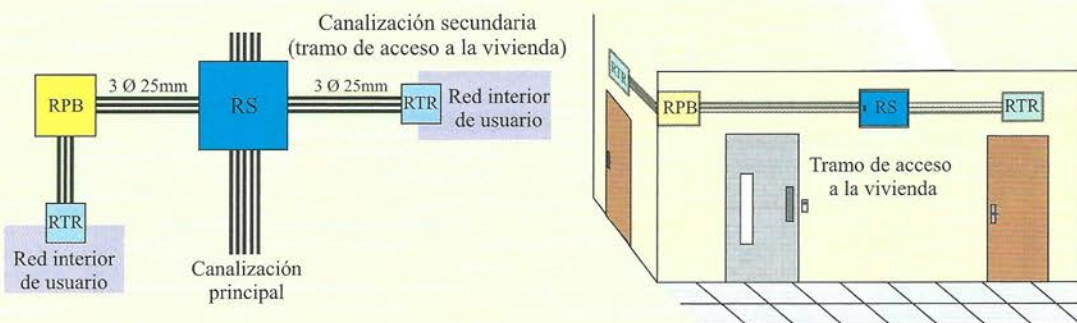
Ejemplo de canalización secundaria PAU/PLANTA < 6 .
